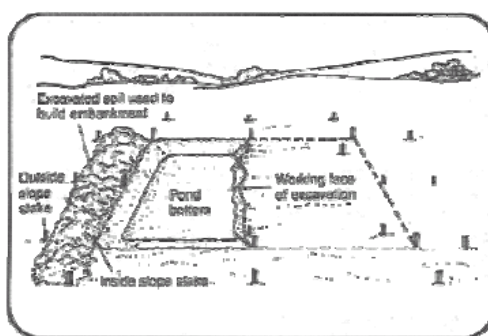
Excavación de una laguna de estabilización.(OPS/CEPIS/05.1641)
